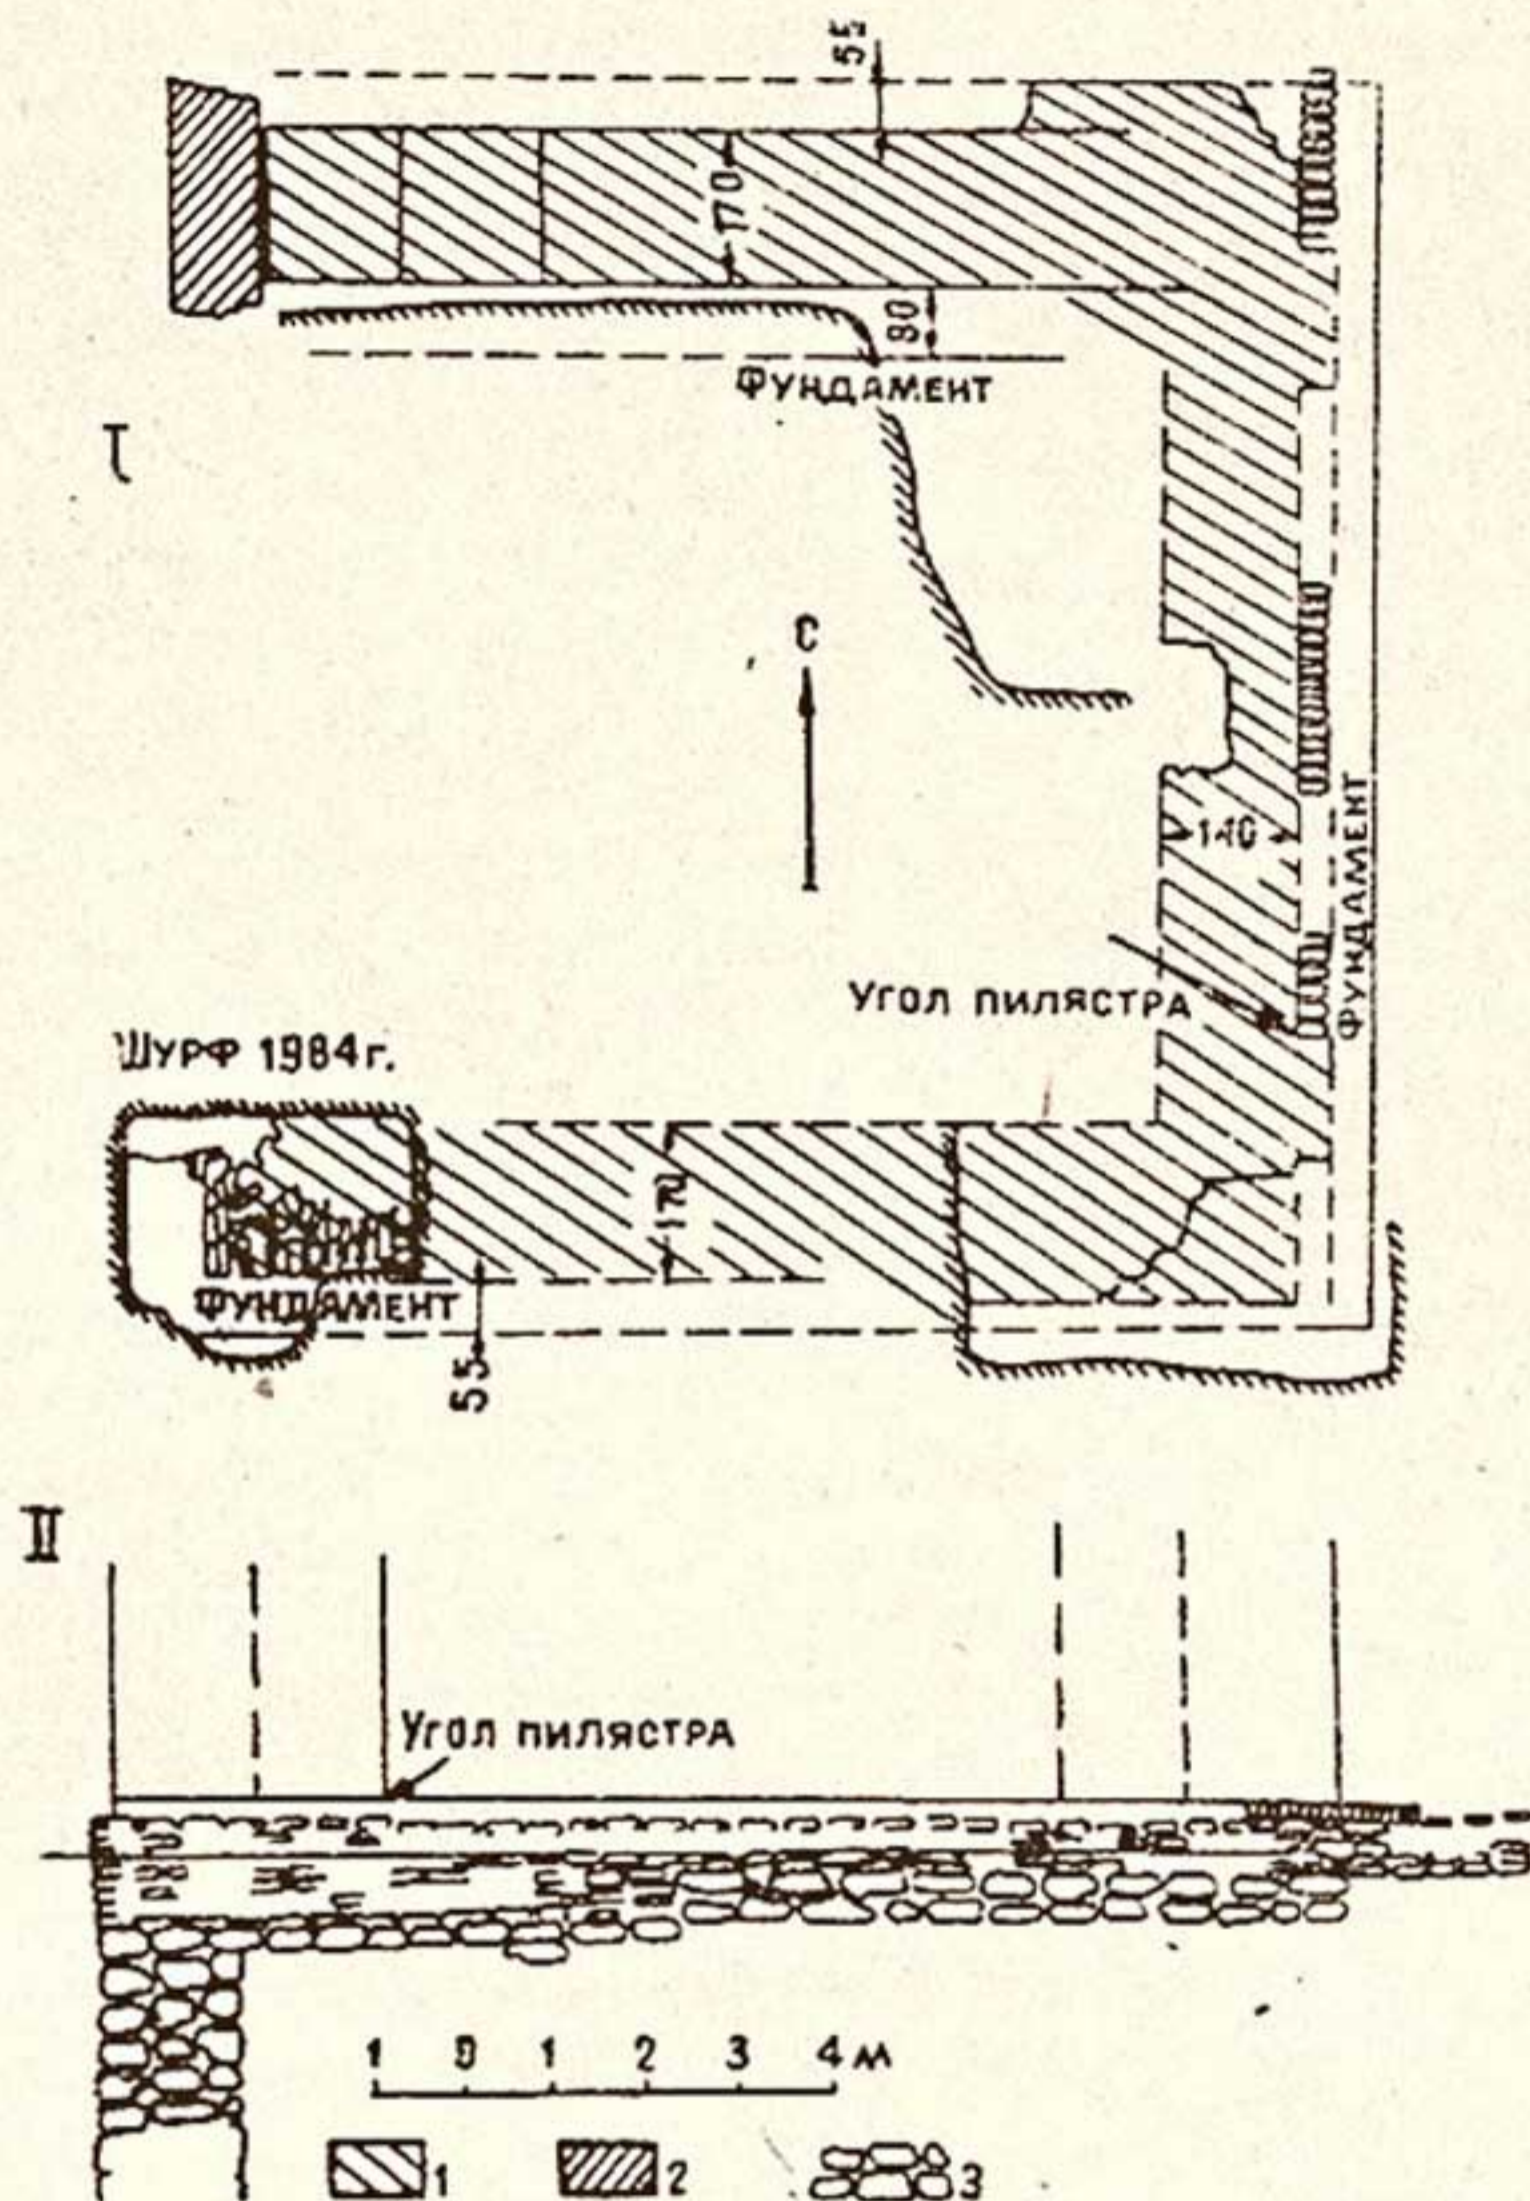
План мавзолея XII в. (I) и разрез фундаментов главного фасада (II):
